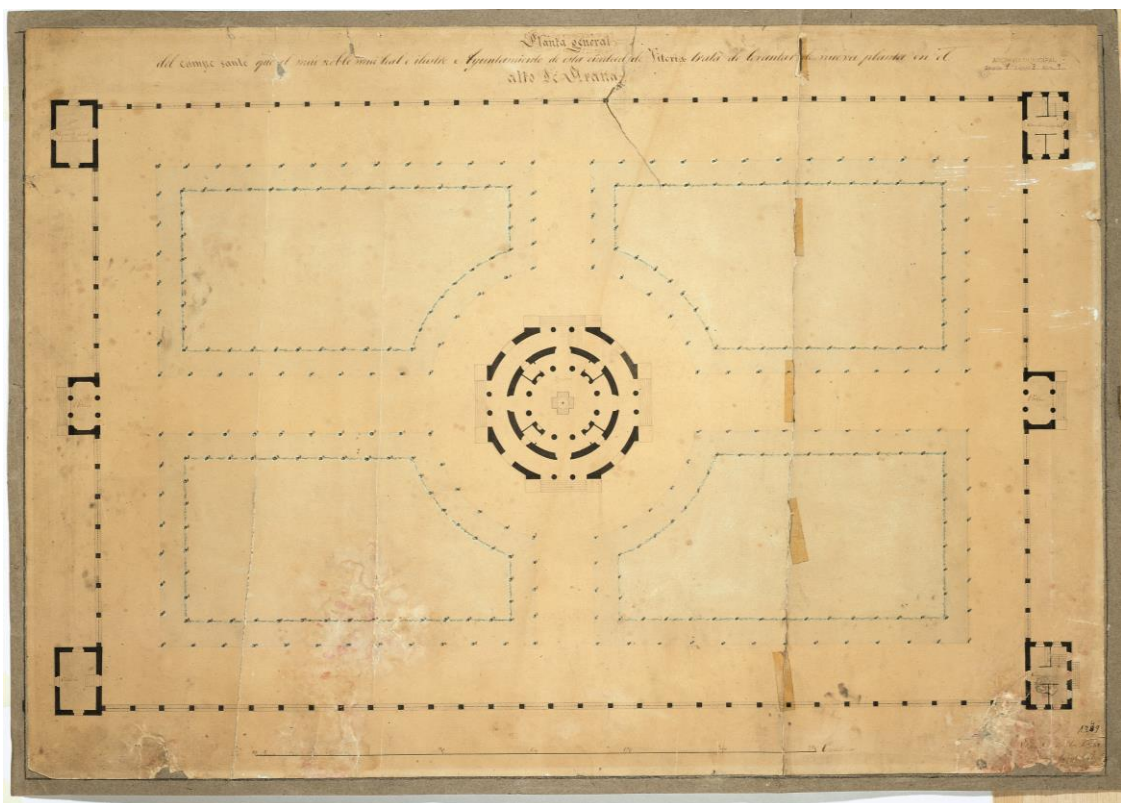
Planta general del proyecto de Saracibar, 1849. Foto: AMV.
